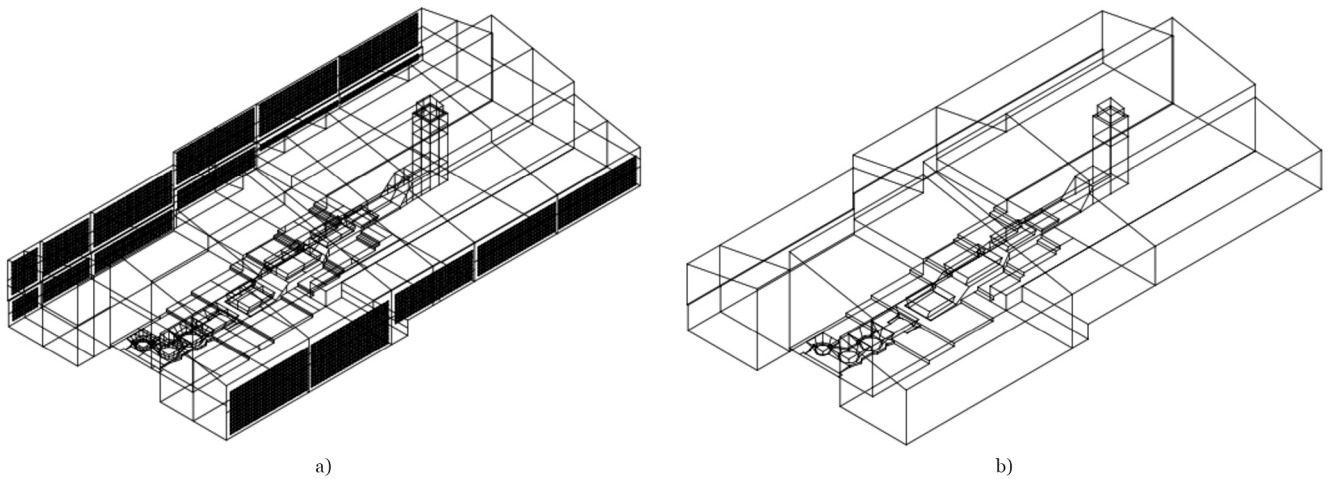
Geometría CAD 3D de la instalación para elaboración de panela.
